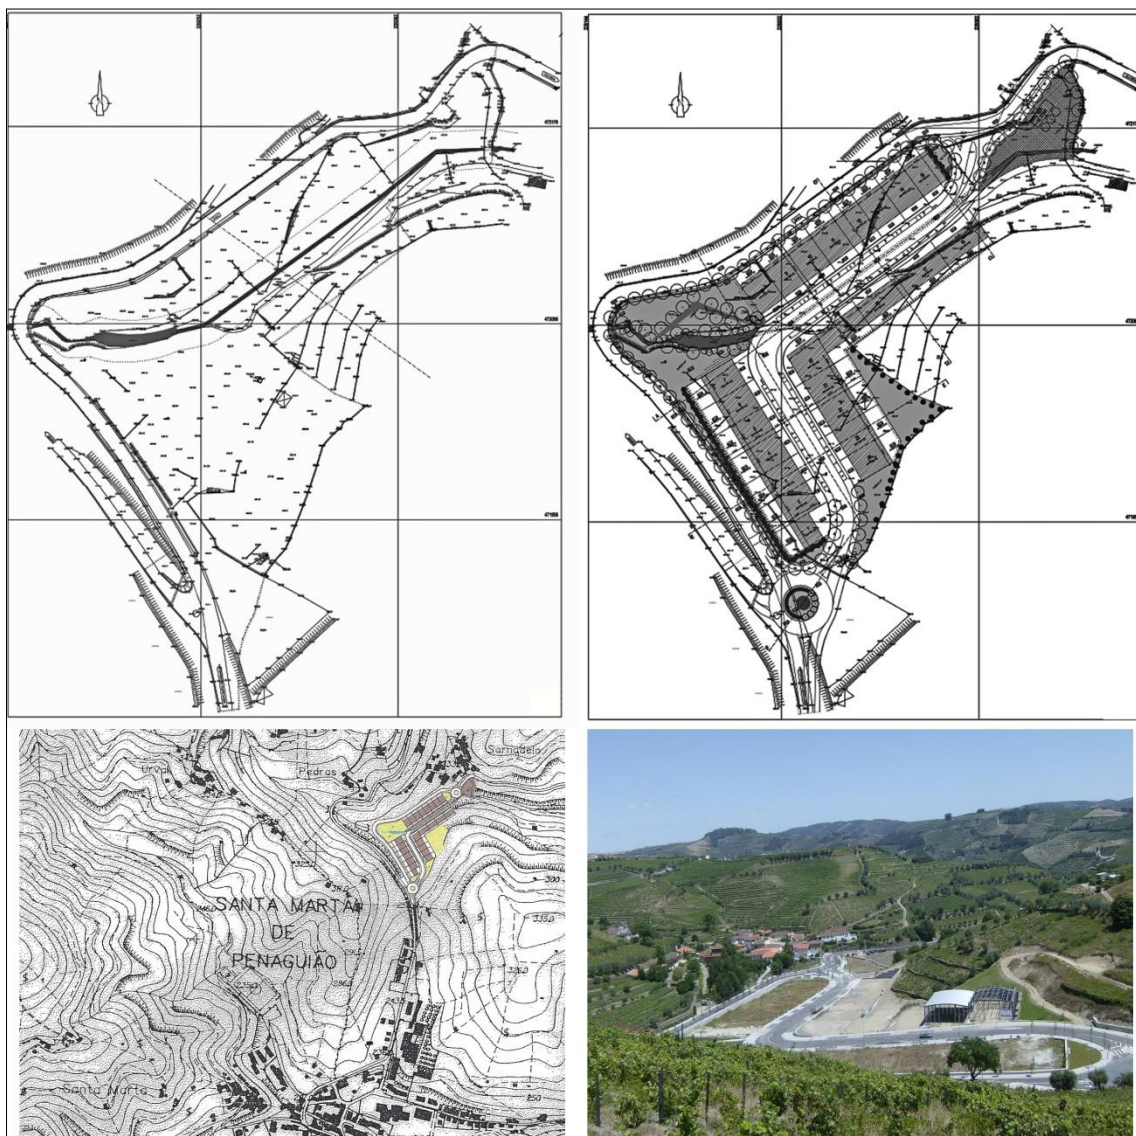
Plantas da zona oficial: Localização, situação existente e proposta (2008)
